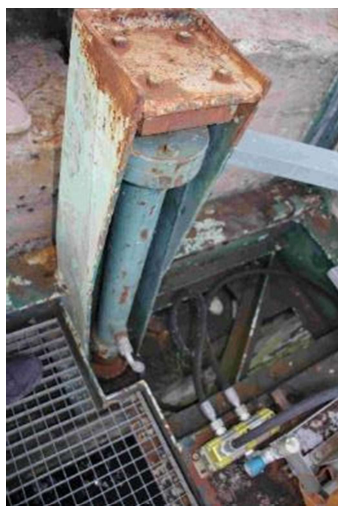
et Photo 13 : La Chaînette – vérin hydraulique P1
